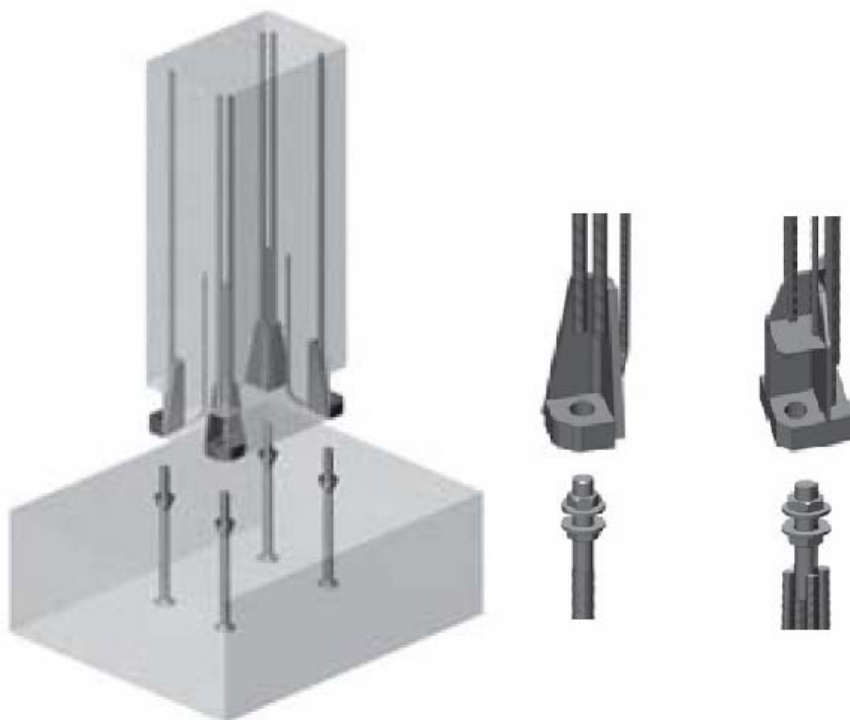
Pormenor de ligação pilar – fundação comercializada pela empresa “PEIKKO”
